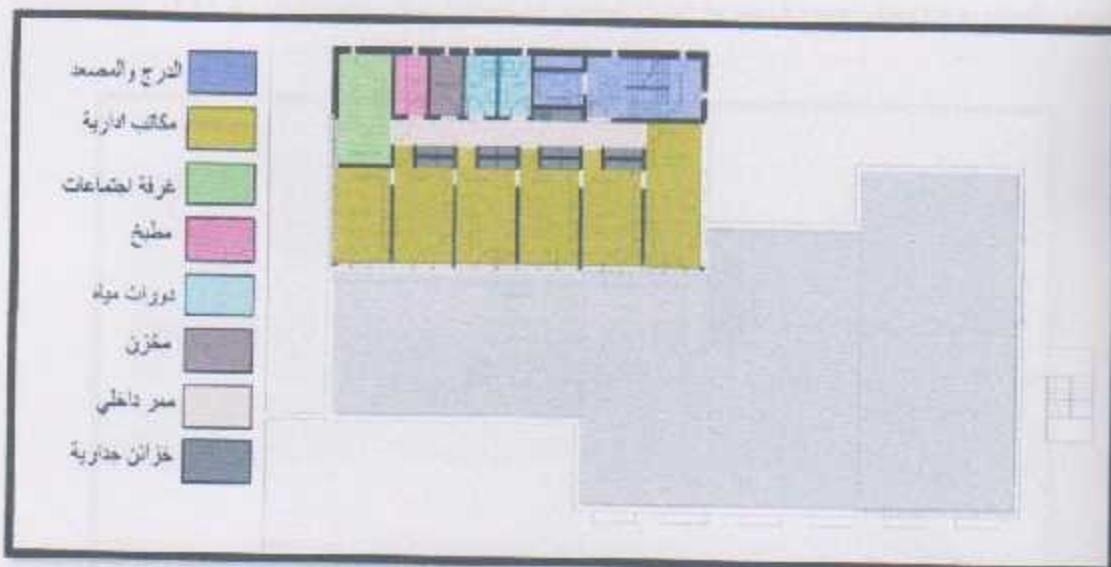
المسقط الأفقي للطبق الأول مكرر في سنتي Veronica House Elderly Care Facility
